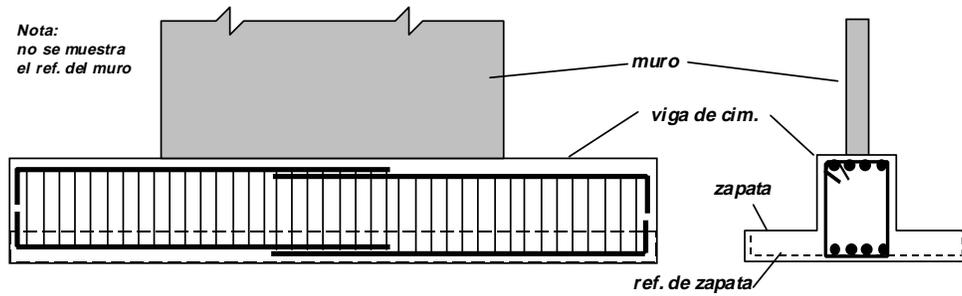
Refuerzo de zapata de muro y viga de cimentación
